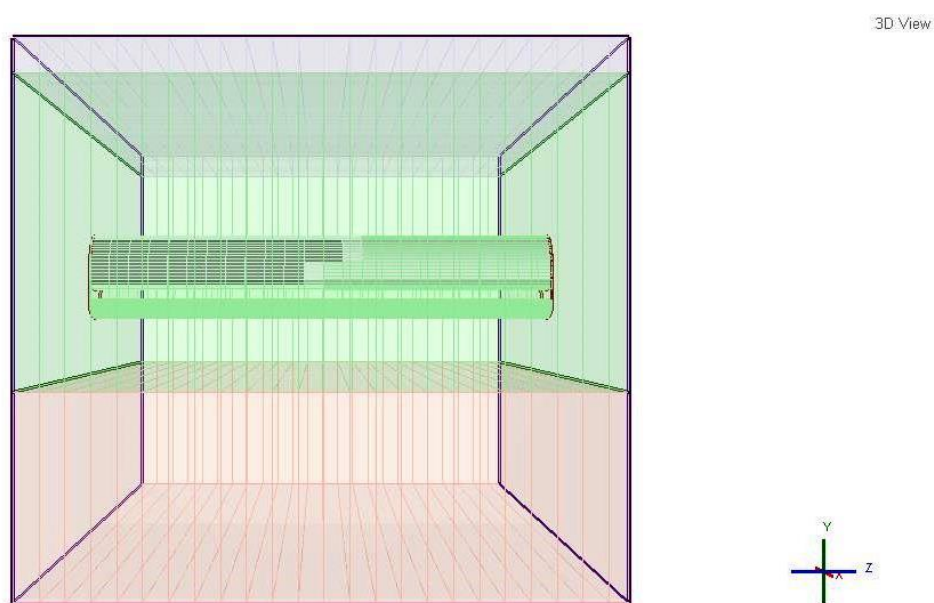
Sequência construtiva da 1ª fase de escavação
